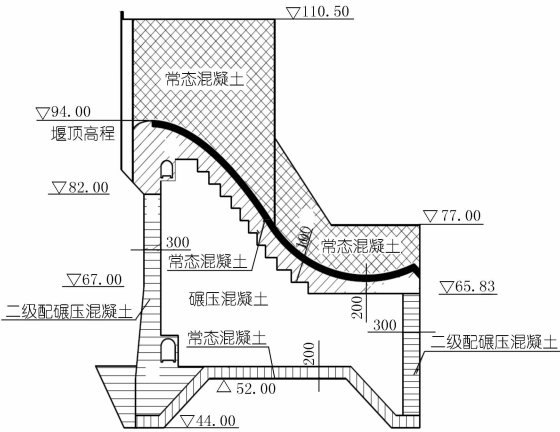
大坝混凝土分区示意(单位: 高程 m, 尺寸 cm)
